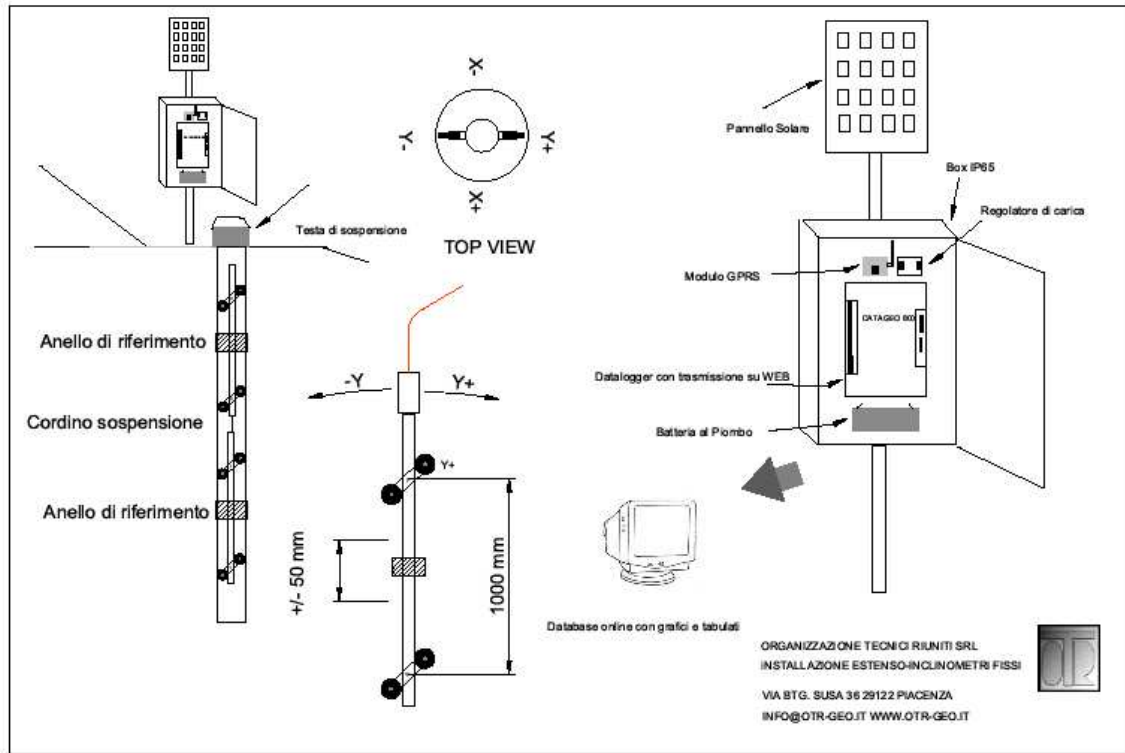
Esempio Installazione Estenso Inclinatori Fissi - Centraggio dell'anello
